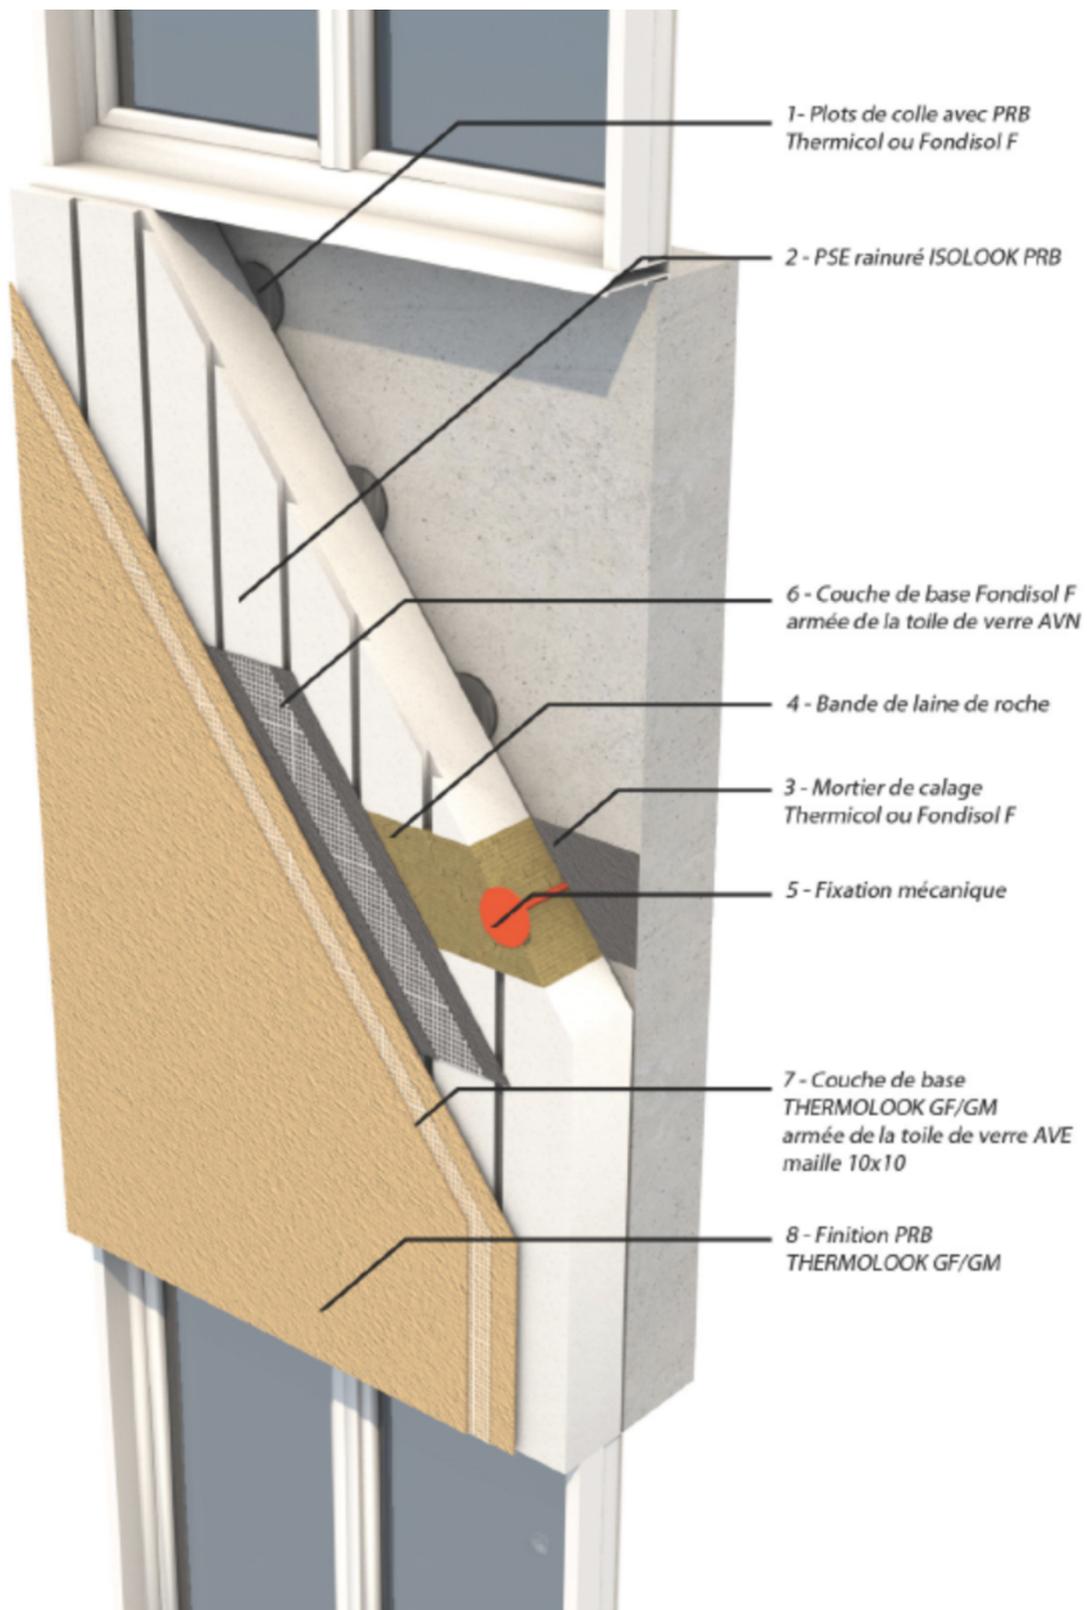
Vue en coupe du système complet au droit d'une bande filante
